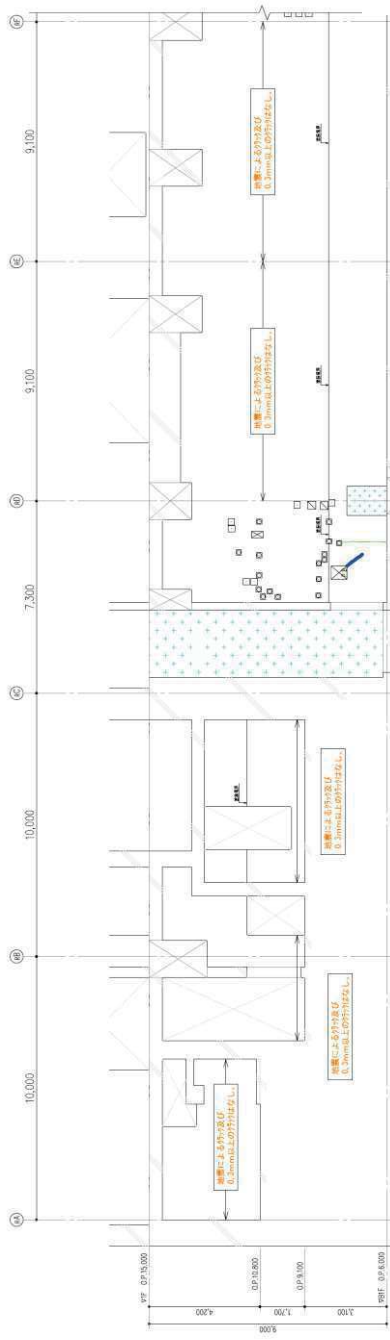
原子炉建屋のひび割れ分布 耐震壁 (21) 地下 1 階 R2 通り
